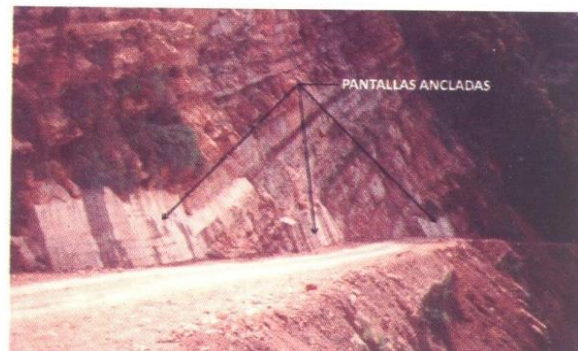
Pantallas ancladas construidas a lo largo de las capas de arcillolitas inferiores
